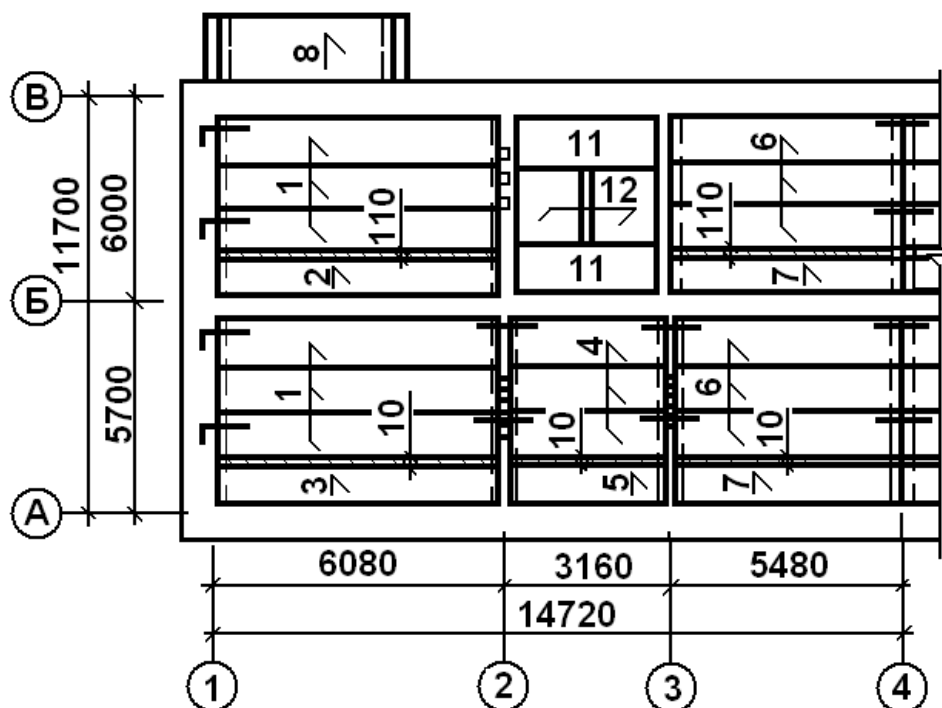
Пример оформления плана перекрытия здания с продольными несущими стенами
